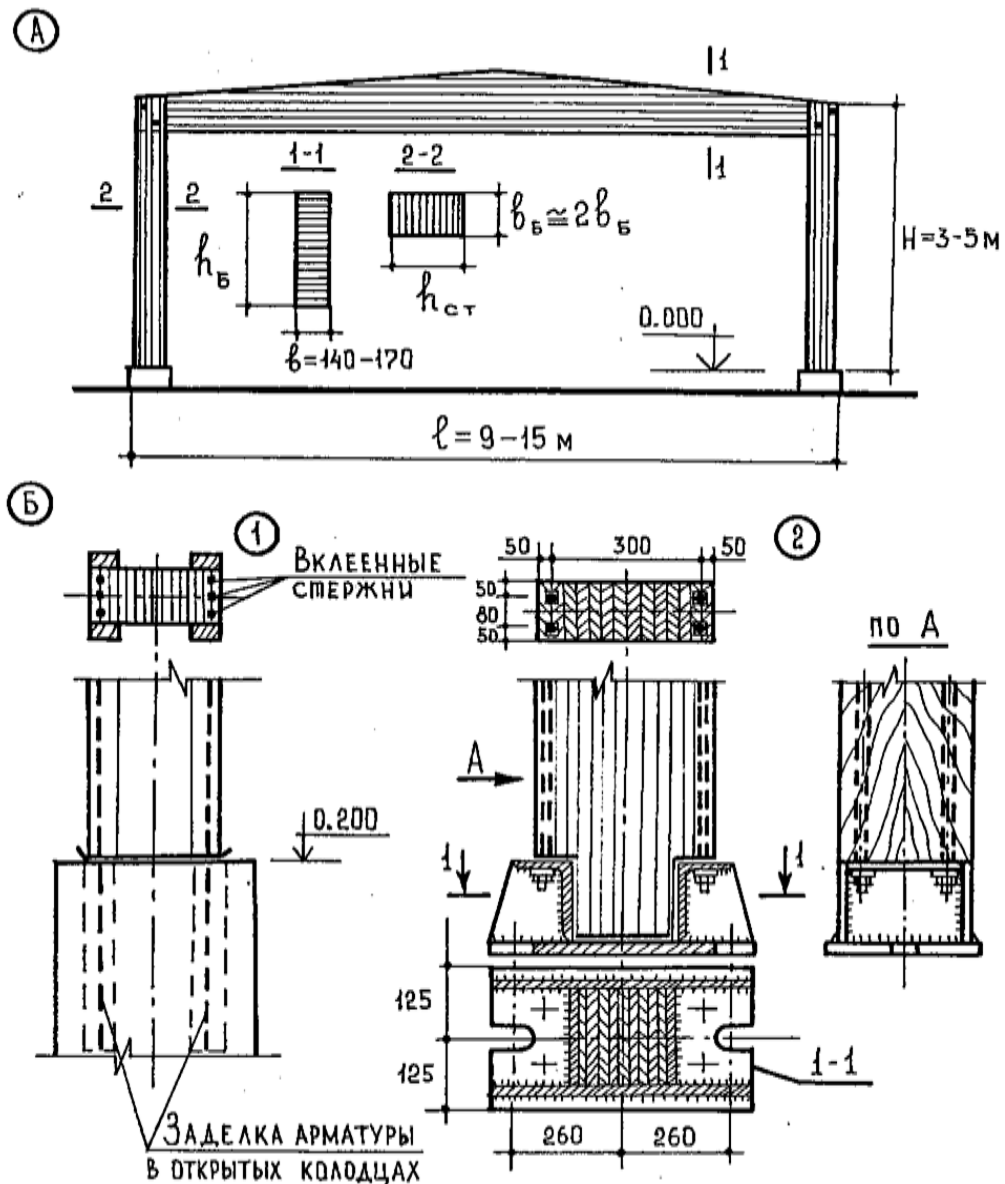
Двухшарнирная рама с жесткой заделкой стоек в фундаменте (А) и два варианта жесткой заделки стойки в фундаменте (Б): 1 – за счет вклеенных в стойку арматурных стержней замоноличенных в фундаменте; 2 – с вклеенными в стойку стержнями, соединяемыми со стальной базой на болтах.
